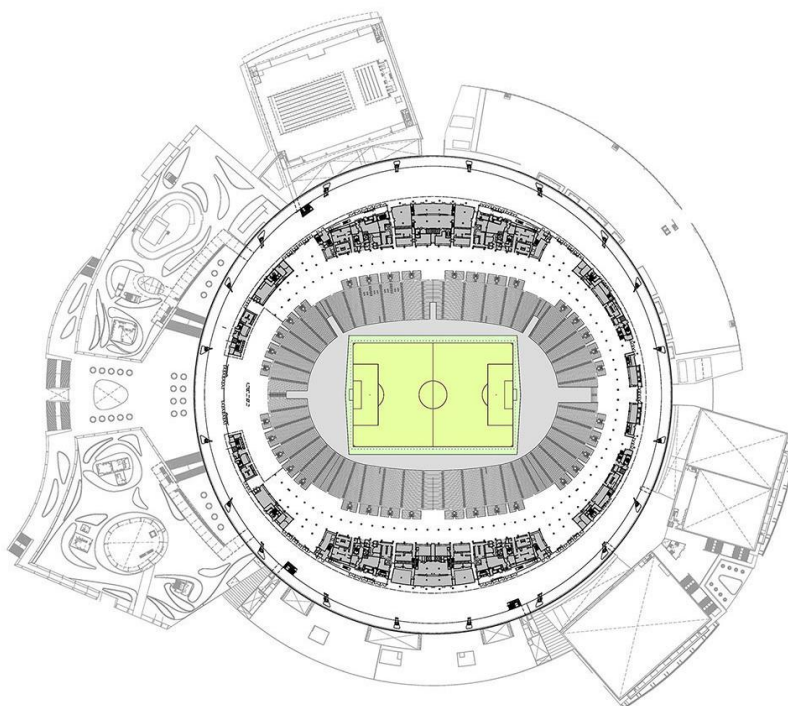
Planta Arquitectónica de Estadio Nacional de Singapur.
